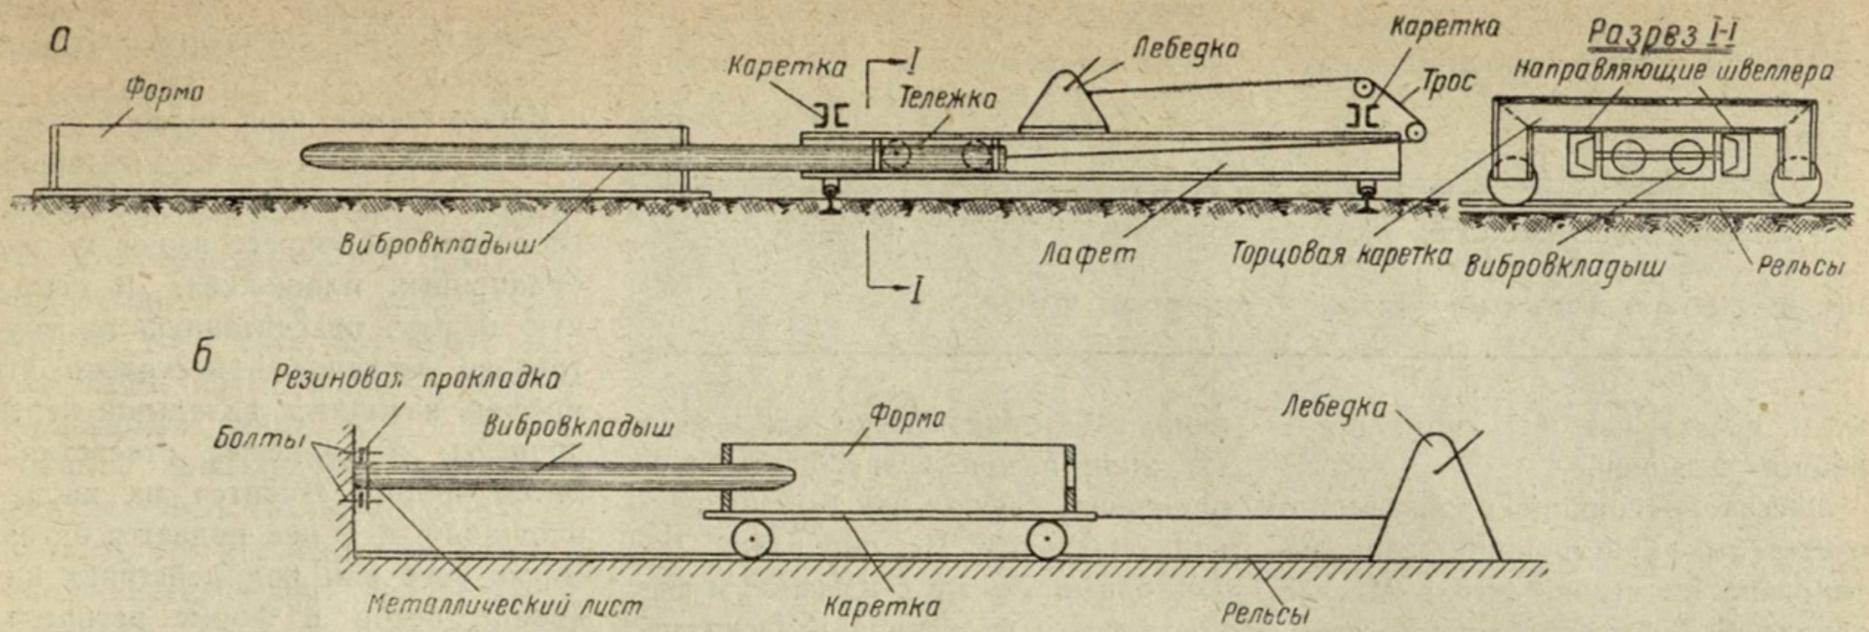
Схемы станков для изготовления пустотелых конструкций: а) станок с подвижными вибровкладышами на лафете и неподвижными формами; б) станок с неподвижными вибровкладышами и подвижной формой.
